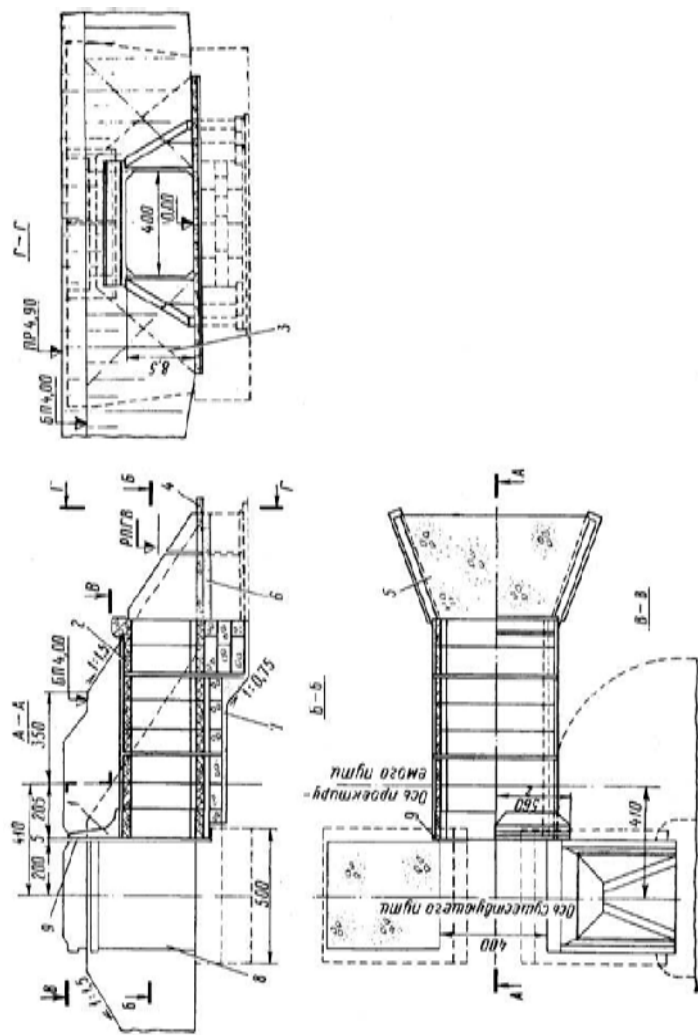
Пристройка типовой прямоугольной водопропускной железобетонной трубы (размеры в сантиметрах):
